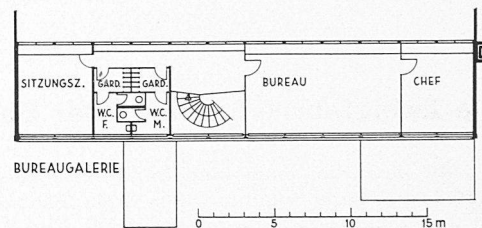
Erdgeschoss mit Bürogalerie, 1:500
